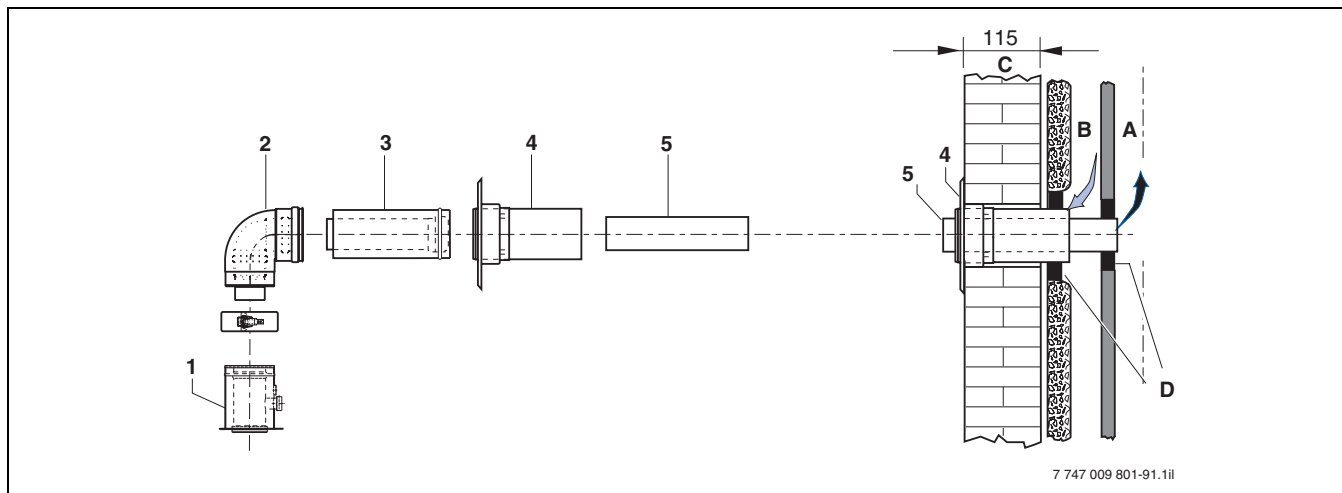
Bauteile des Grundbausatzes LAS-K für U152 (Maße in mm)
